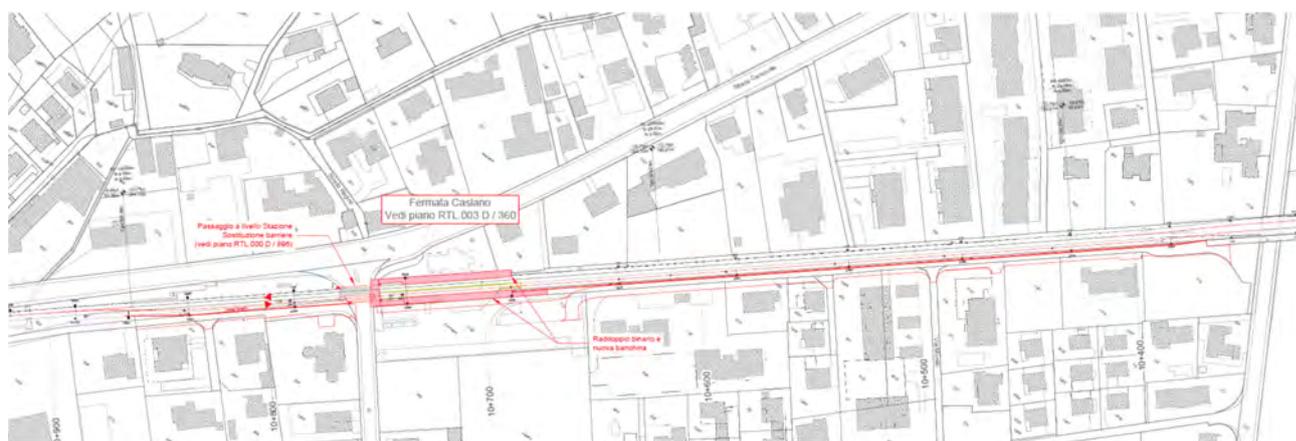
Planimetria del raddoppio di binario tra la via golf a Caslano e la fermata di Caslano.
